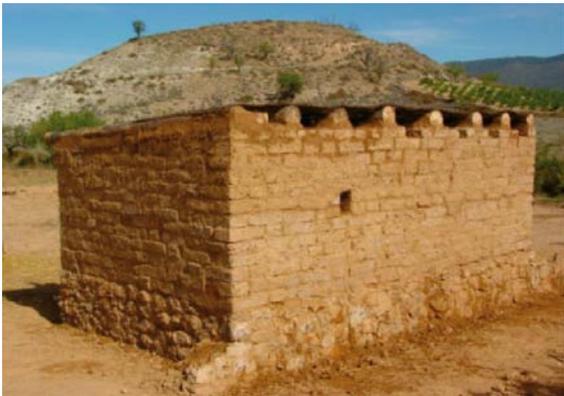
La maison avant l'application des enduits d'argile et de chaux.
